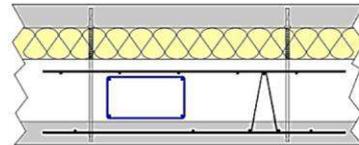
Poteau coulé en place au droit d'un joint vertical – Coffrage d'une face
